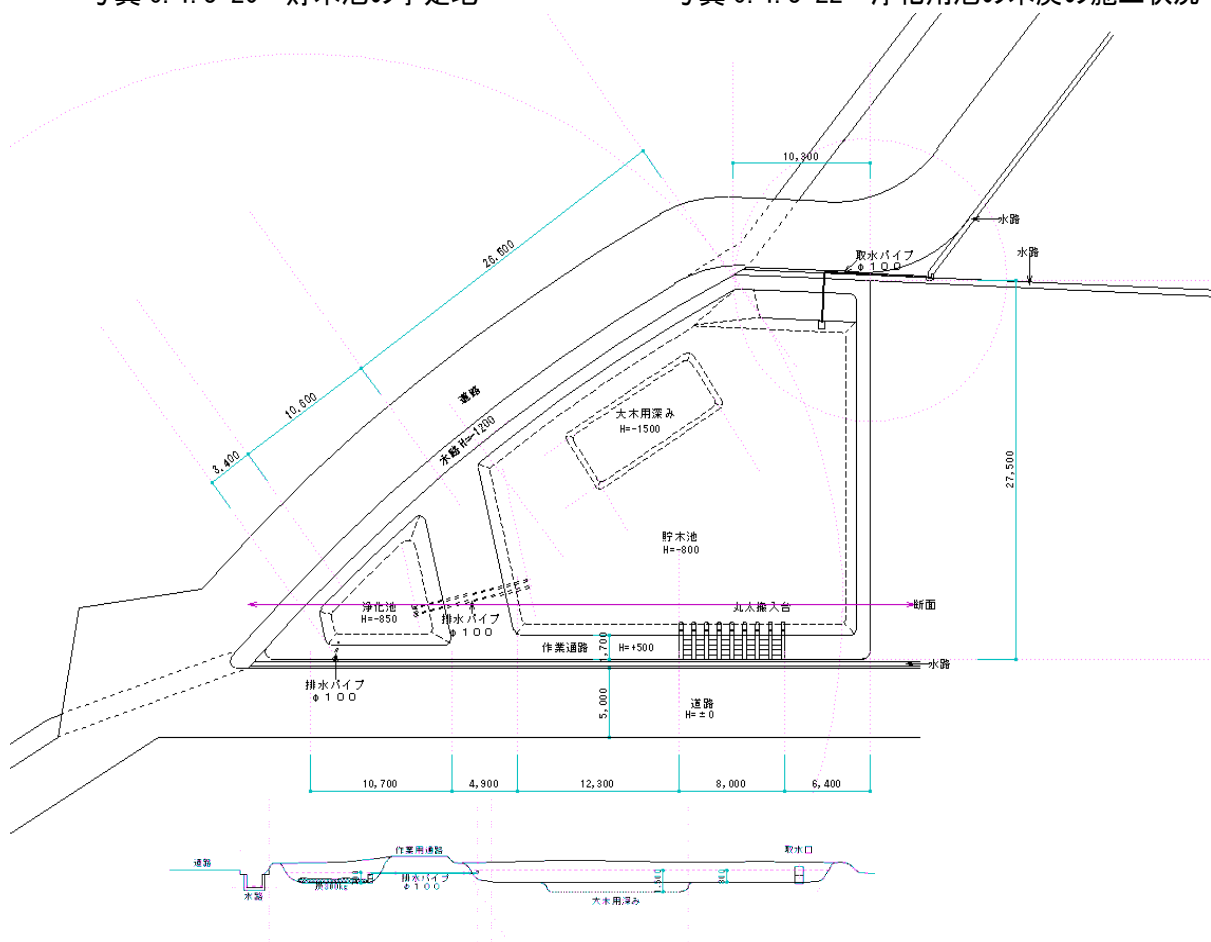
山梨県北杜市武川町につくった貯木池の平面図と断面図
